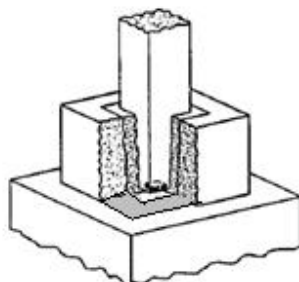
Ligação pilar - fundação (extraída de [1])
